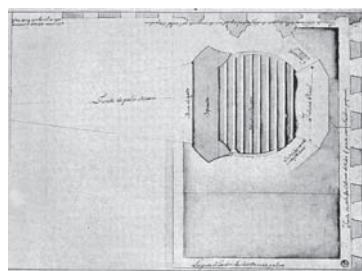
BNL, D.389-108V. Planta de Estudo da Casa da Ópera/Teatro de Queluz.
